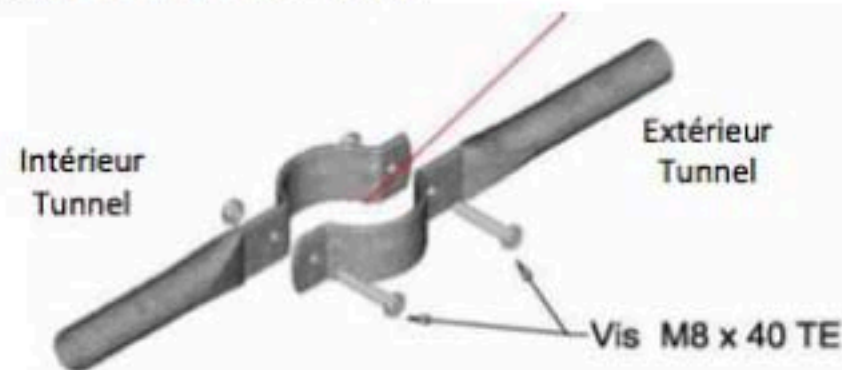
Emboîtement des arceaux sur les fers à béton
